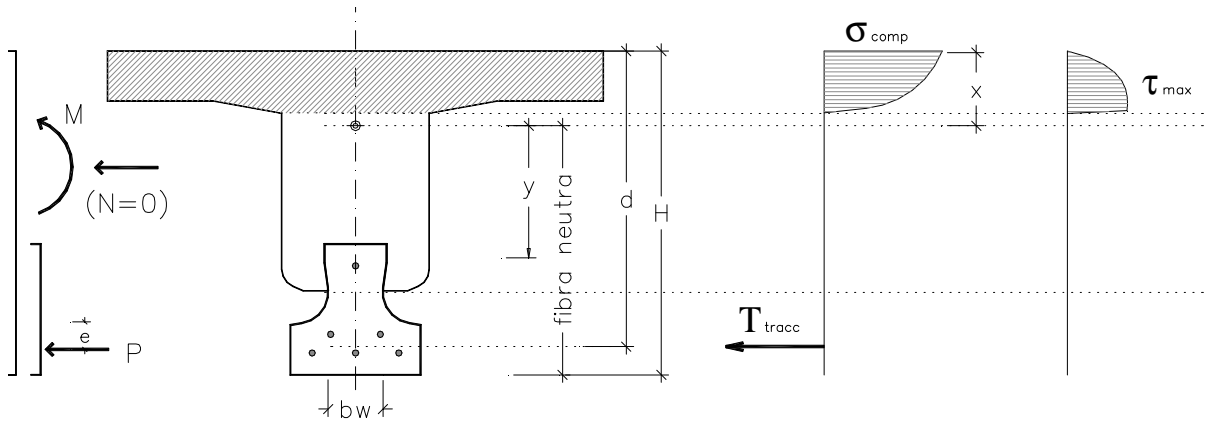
Tensiones en una sección general de un nervio de forjado de vigueta pretensada. Hormigón próximo a la rotura
